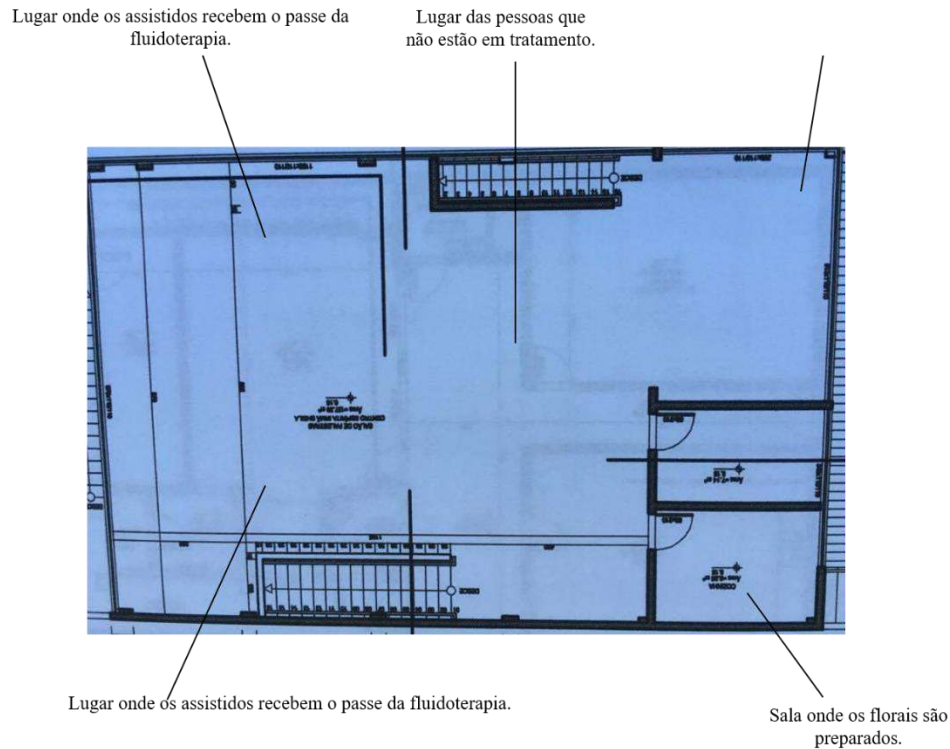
Planta baixa com indicação do salão onde é realizado o tratamento.
